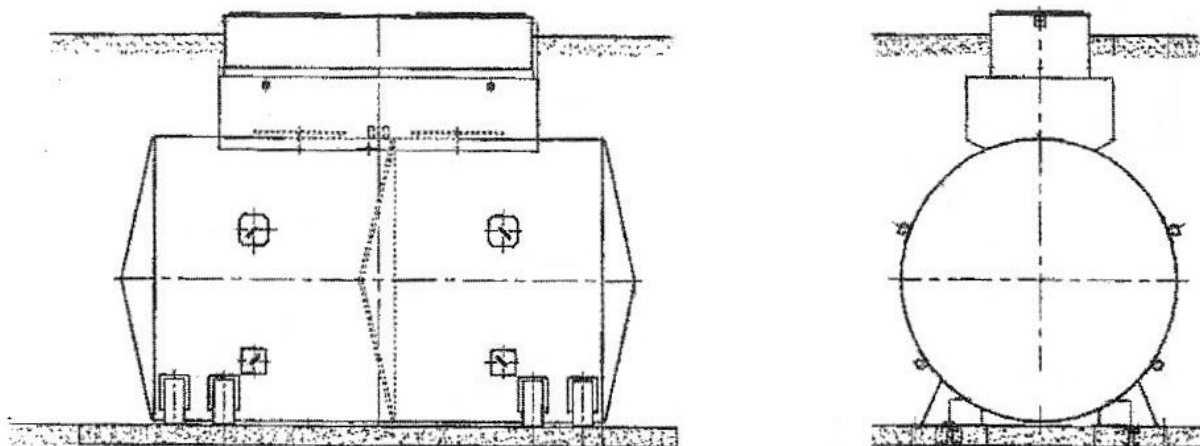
Общий вид эскиза резервуаров РГС-20
